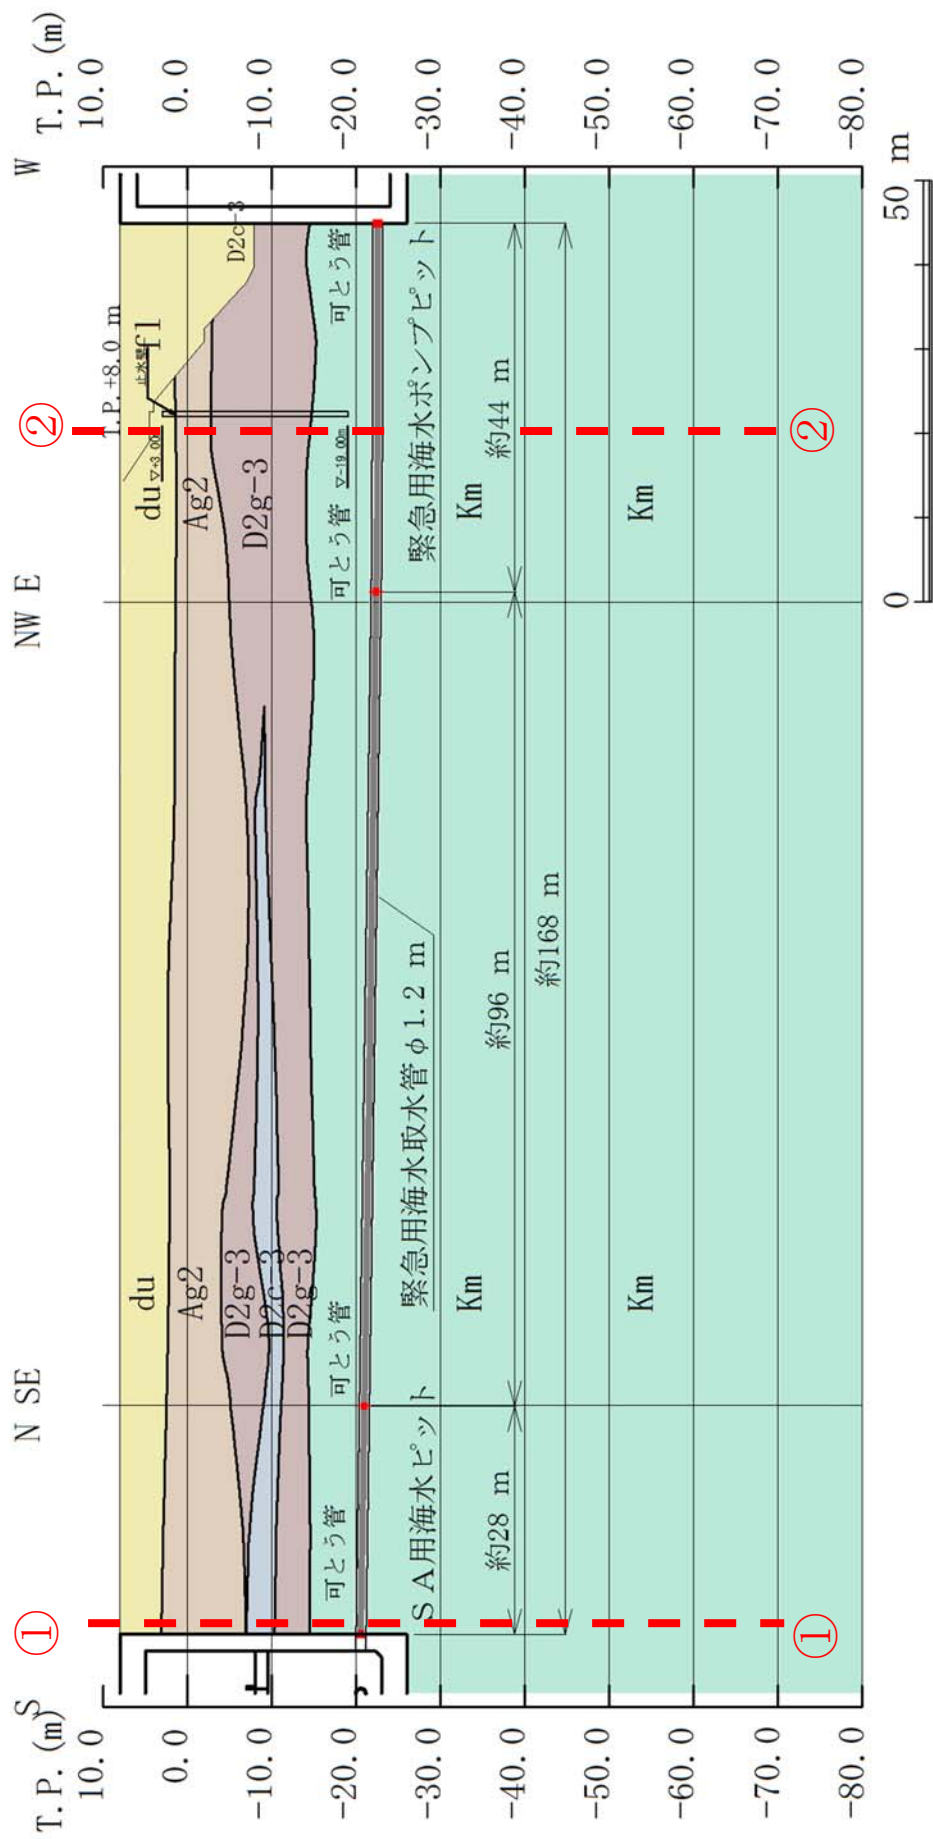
緊急用海水取水管 縦断面図 (A-A断面)
